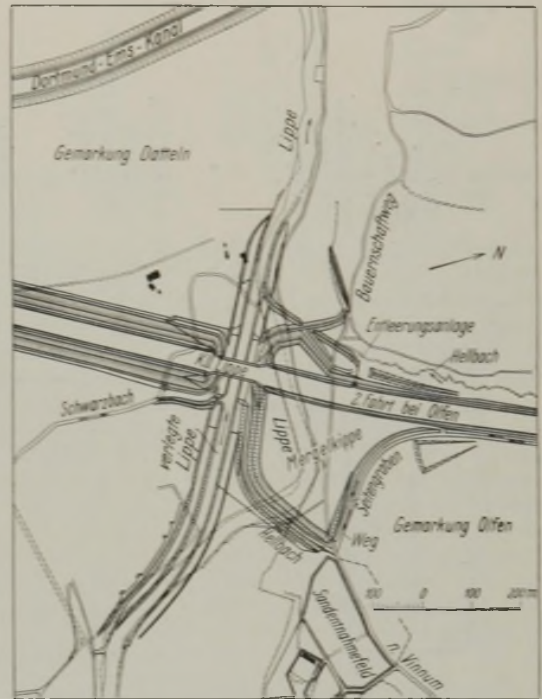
Lageplan der Kanalüberführung Lippe mit Verlegung der Lippe und des Bauerschaftsweges.
